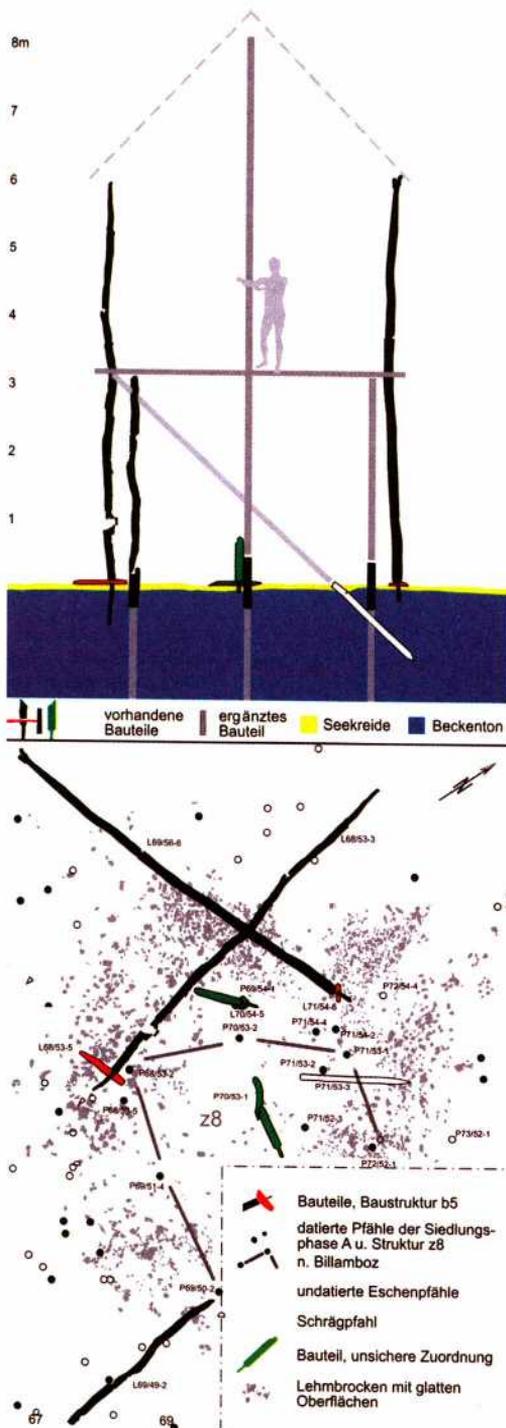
Planausschnitt und Rekonstruktion der Hausstandorte Hornstaad anhand der Pfahlbefunde und liegenden Hölzer (DIECKMANN et al. Abb. 69, 117 f.).
